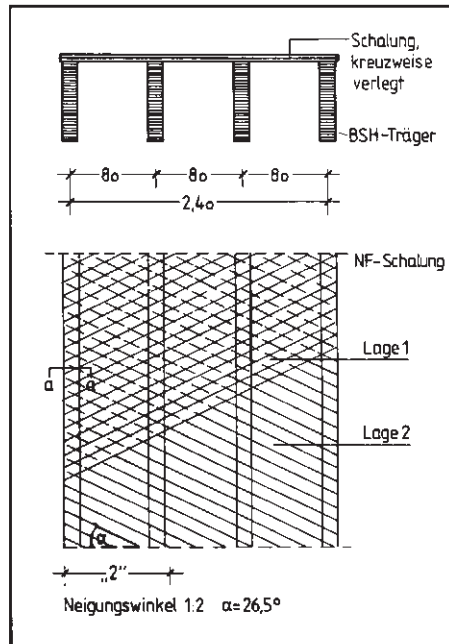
Kreuzweise verlegter Belag; Draufsicht und Schnitt
